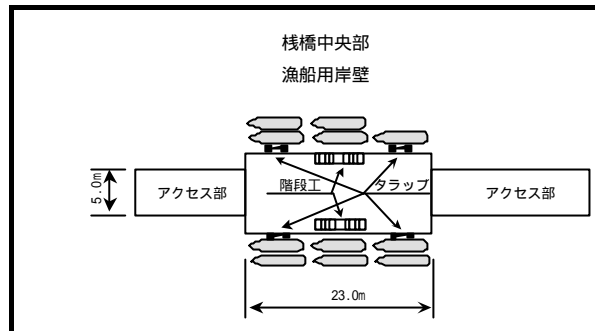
漁船用岸壁の平面配置計画概要図
